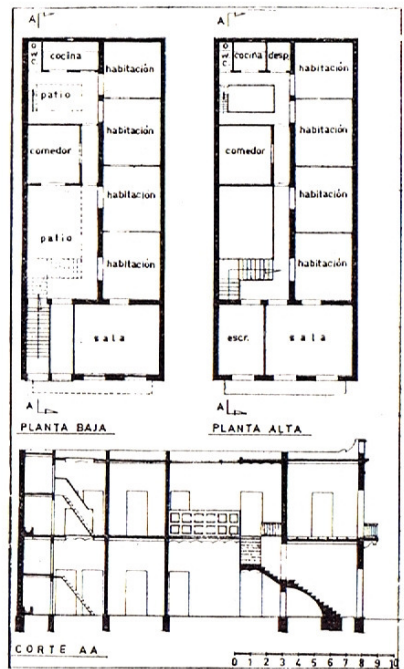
Casa "Standard" de 2 plantas — Plantas y corte.
